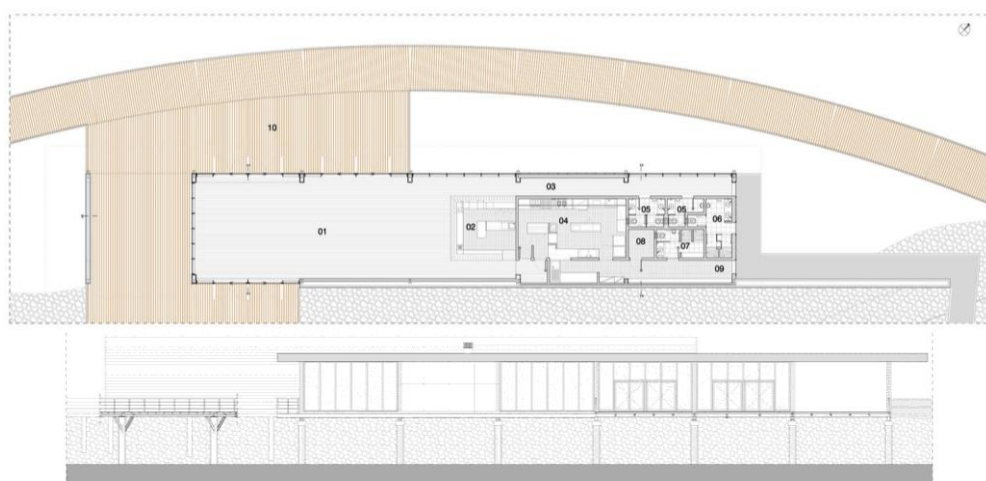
Planta baixa e corte longitudinal do bar/restaurante (sem escala).
